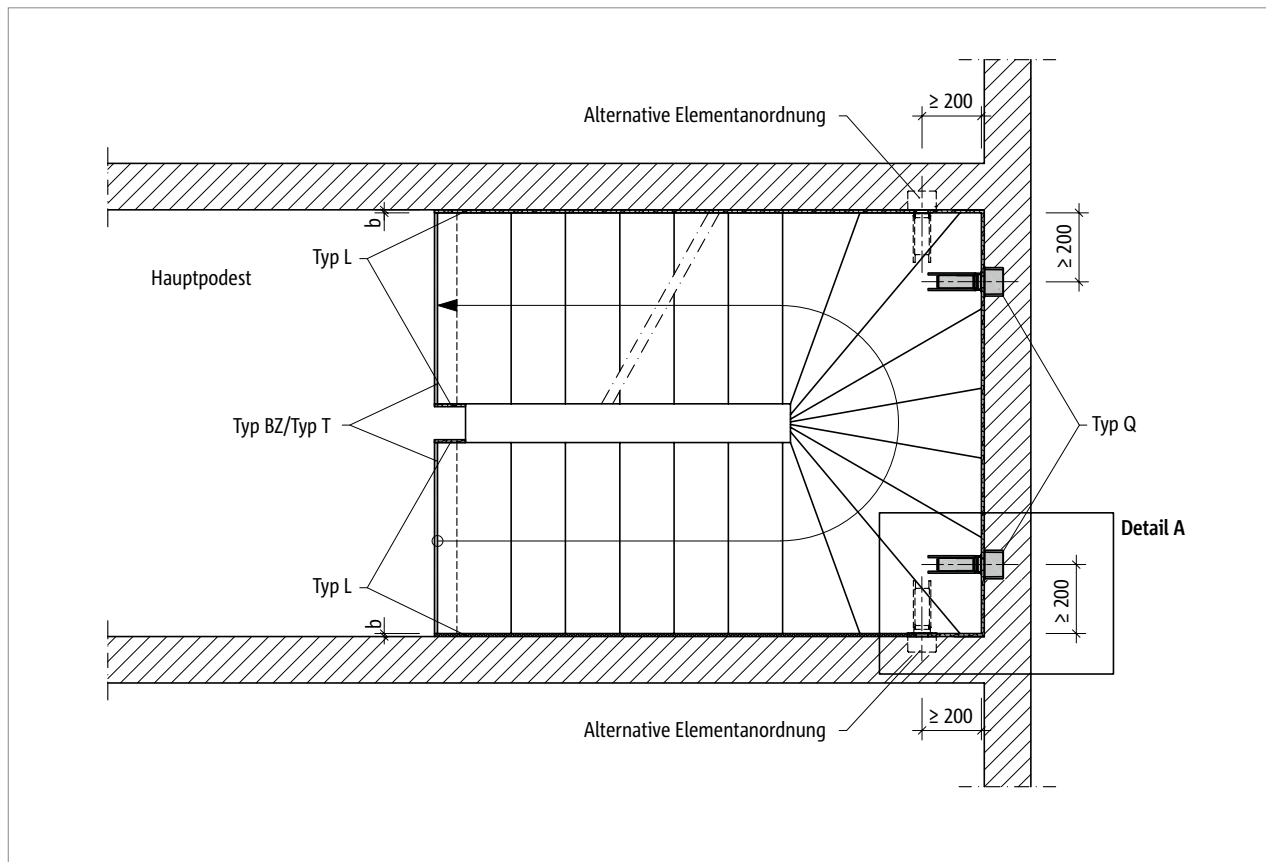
Schöck Tronsole® Typ Q...-XL: Elementanordnung im Grundriss bei einer Fugenbreite von maximal 100 mm
